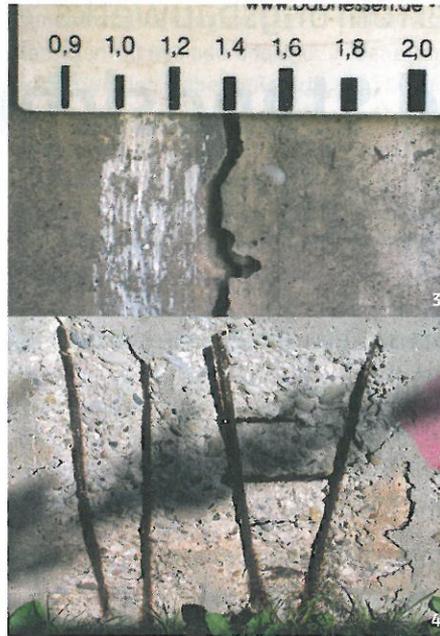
Vor der Sanierung durchgezogene Risse viele Bauteile der Unterführung (Rissbreite im Bild $w = 1,4$ mm) ...
